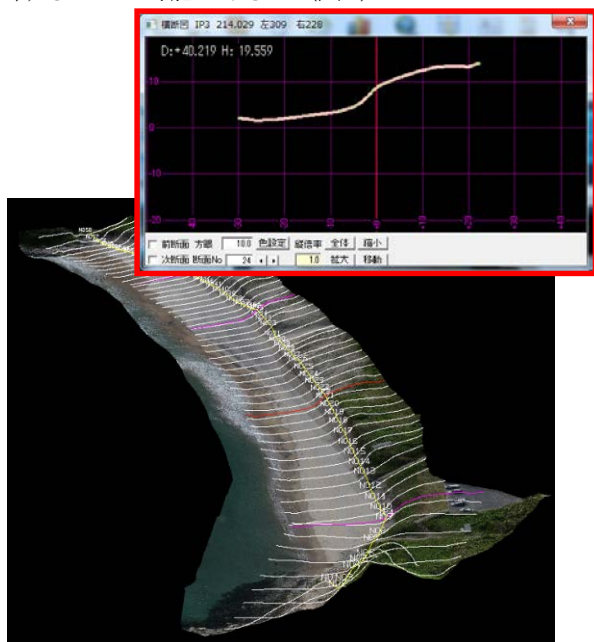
縦横断面図の作成と任意断面での横断面図切り出し
